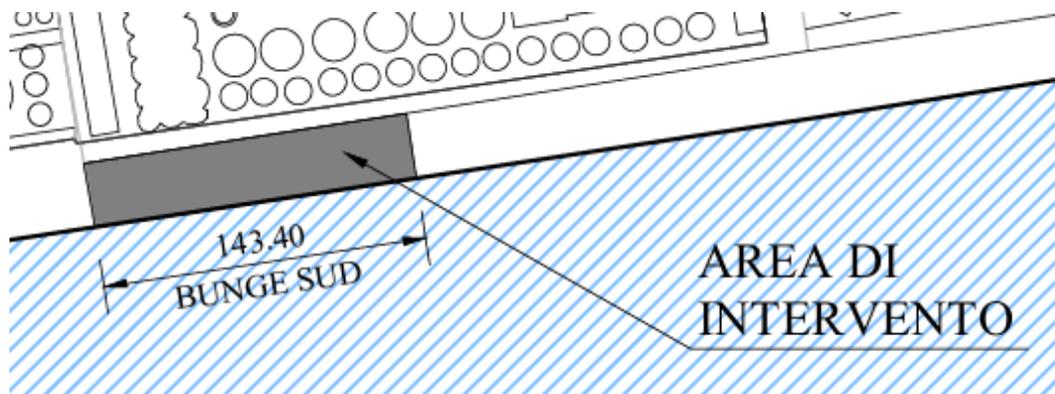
• 1114.STR.04B.01 - Planimetria di inquadramento_Rev.2
